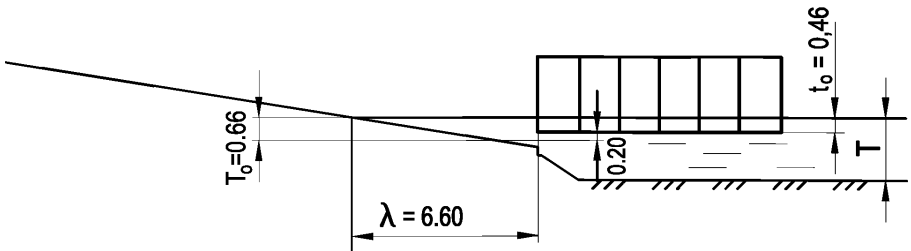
Схема спуска плашкоута Н=3,6 м
